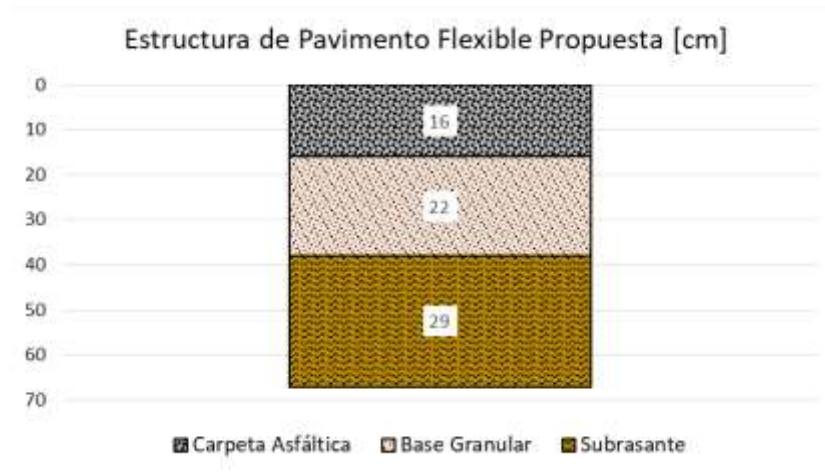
Estructura de Pavimento Flexible Propuesta
